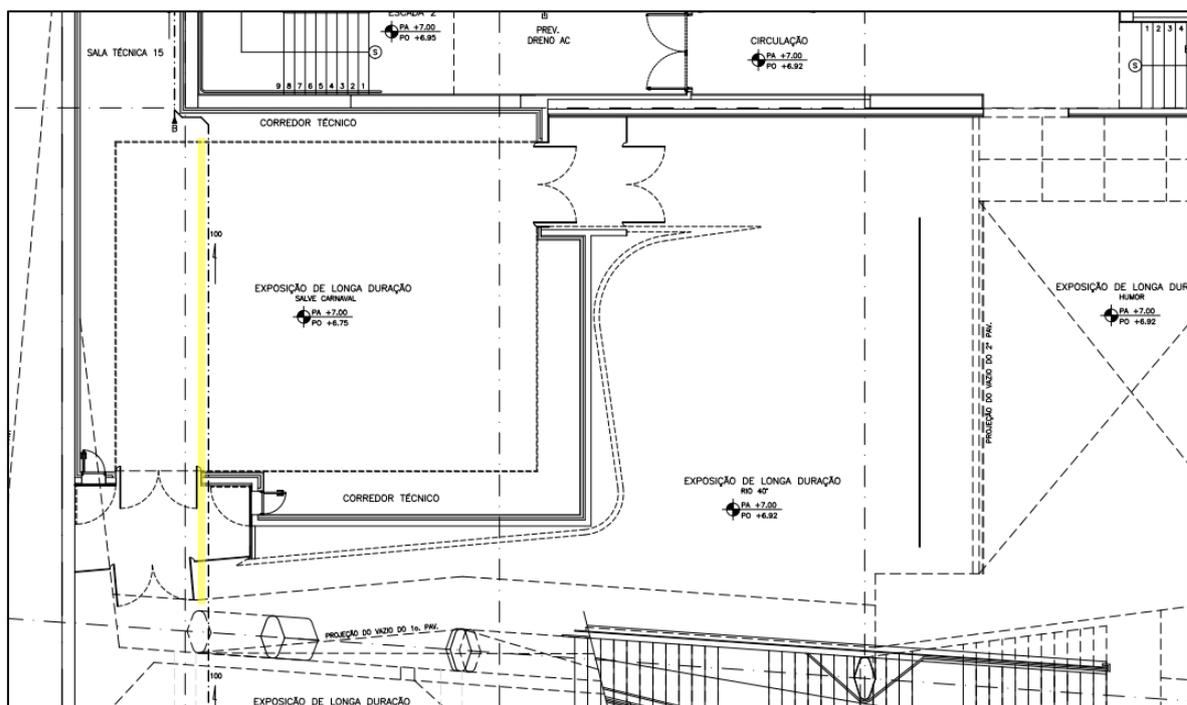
Demonstração da Patologia da Abraçadeira tipo “U – 1º Pavimento
